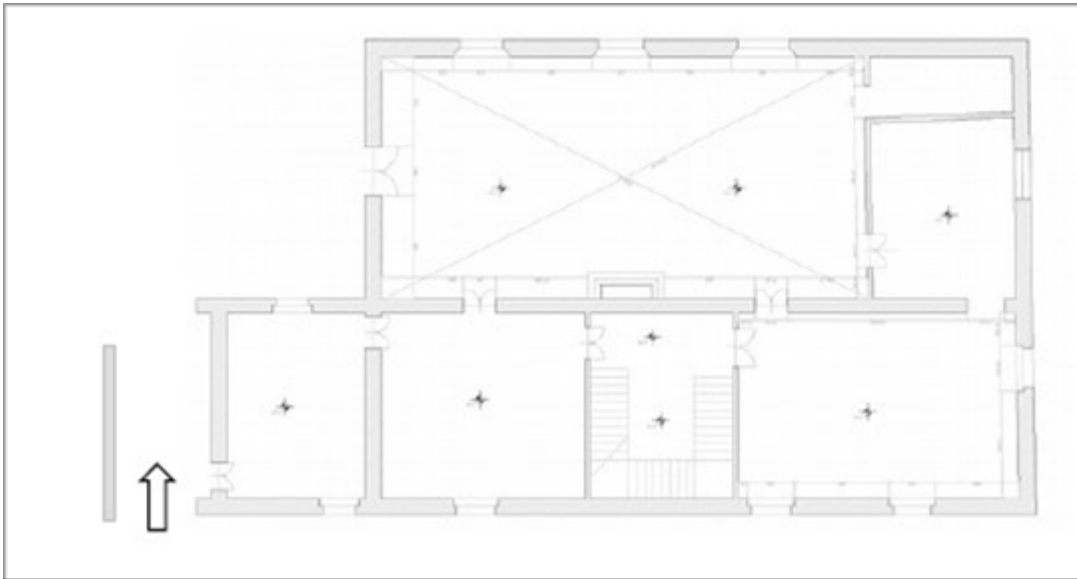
Planimetria dell'ala meridionale monumentale del palazzo con salone a muro di spina longitudinale (in alto).
